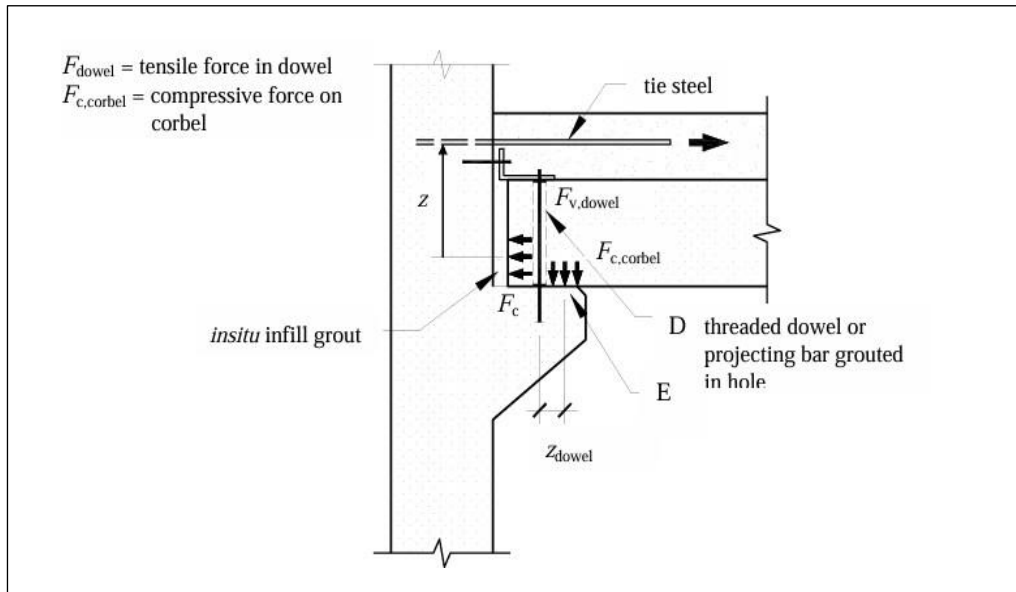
Mécanisme structural d'une connexion sur corbeau en béton armé.
